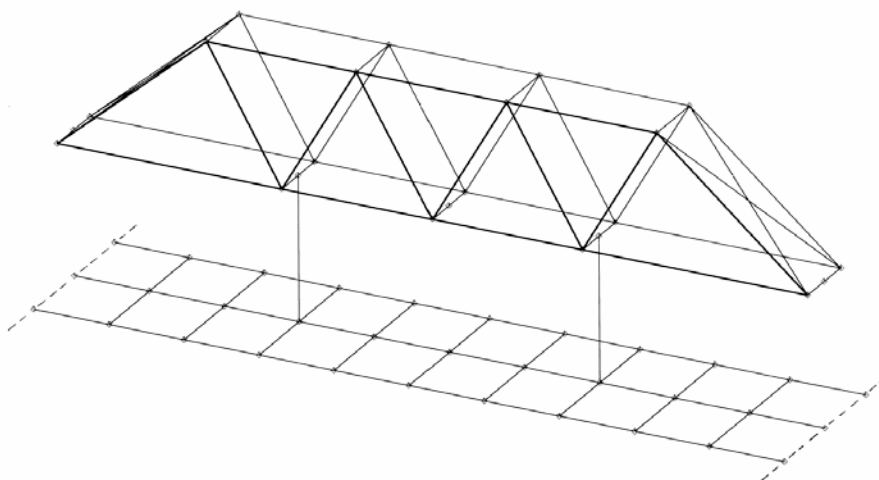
Systemausschnitt des Dachträgers mit angehängter Geschossdecke des Fitness-Studios
